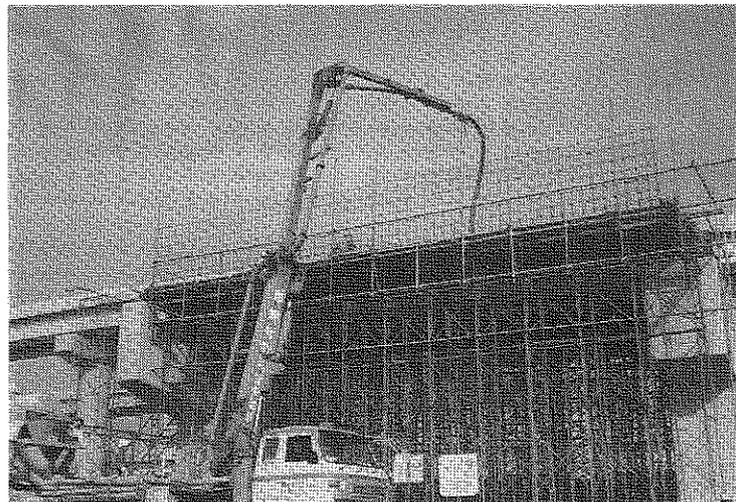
第4辰巳B ℓ単T桁コンクリート打設
